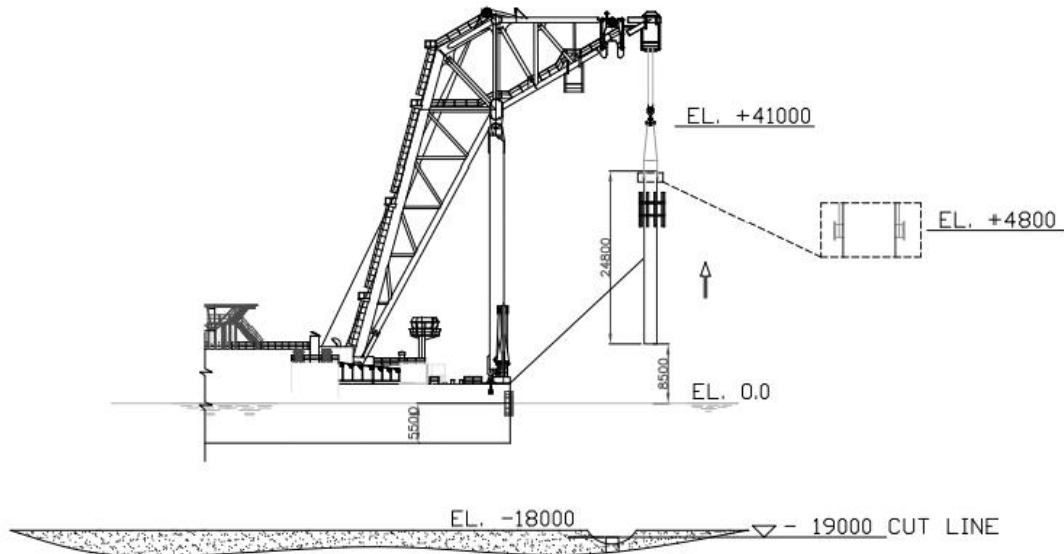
Piattaforma Armida 1 – Sketch di Rimozione Sezione inferiore Sovrastruttura tipico utilizzando Nave Gru a Braccio Fisso
